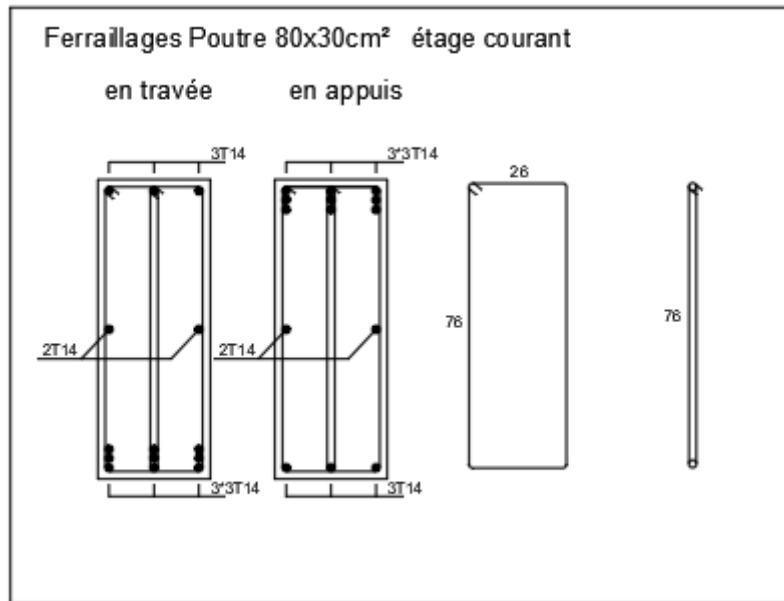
Schéma de Ferraillages poutre étage courant.
